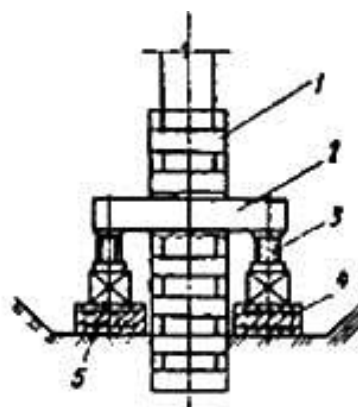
Усиление ленточного фундамента подводкой: 1 – усиливаемый фундамент; 2 – разгружающая балка; 3 – подставка; 4 – распределительный ростверк; 5 – домкрат
